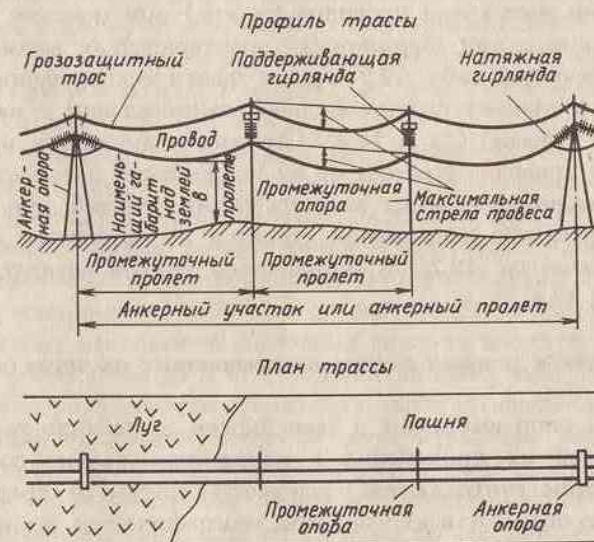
Расстановка опор по трассе воздушной линии (продольный профиль и план)
